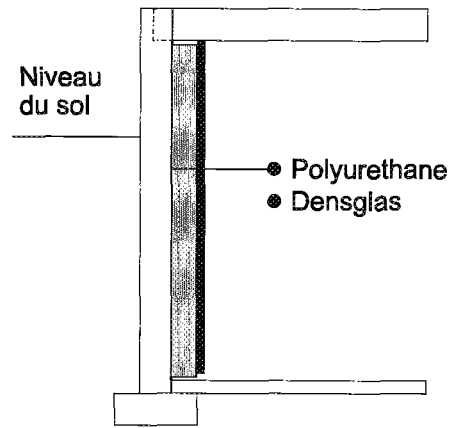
Panneau d'essai 10 – Construction brevetée à poteaux de bois, isolant de polyuréthane et Densglas.
